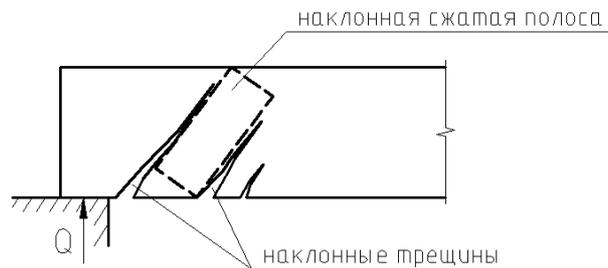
Раздробление бетона наклонной сжатой полосы между наклонными трещинами
